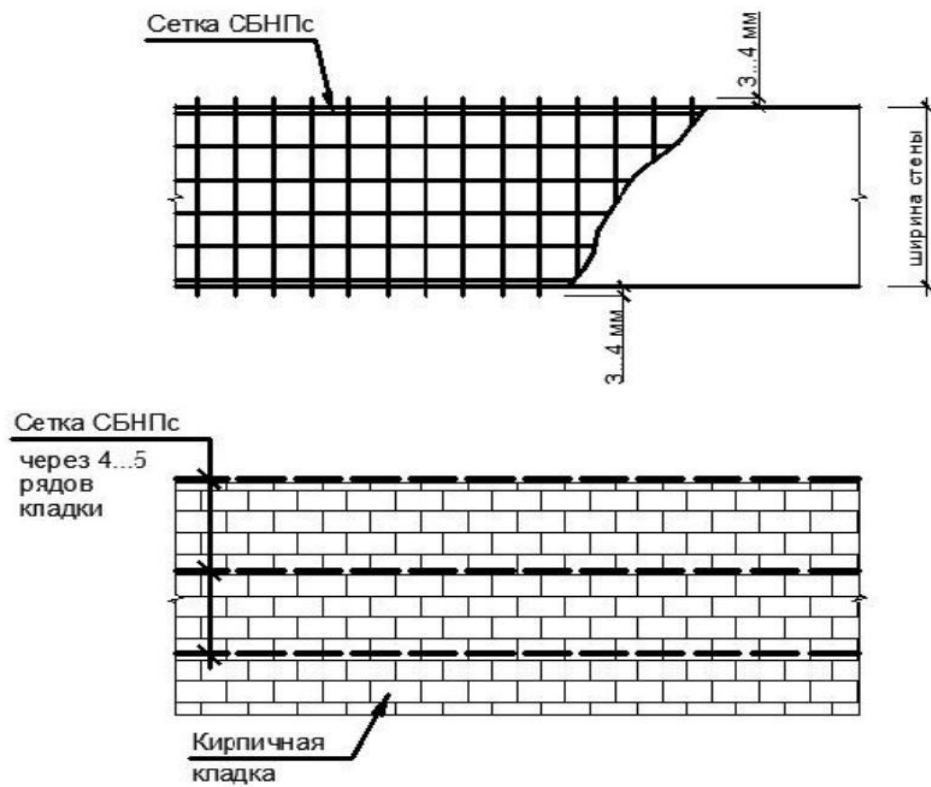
Схема армирования кладки сеткой СБНПс ГРИДЕКС
